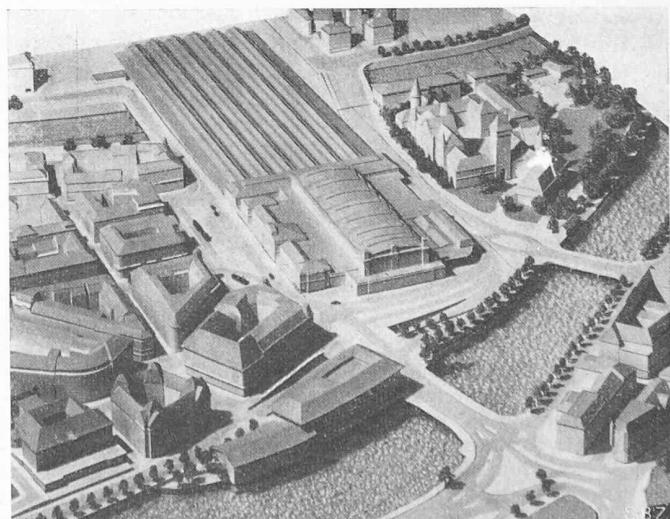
Bestehendes Aufnahmegebäude mit projektierter Strassenunterführung und Neubau Warenhaus Globus; Text Seite 251
